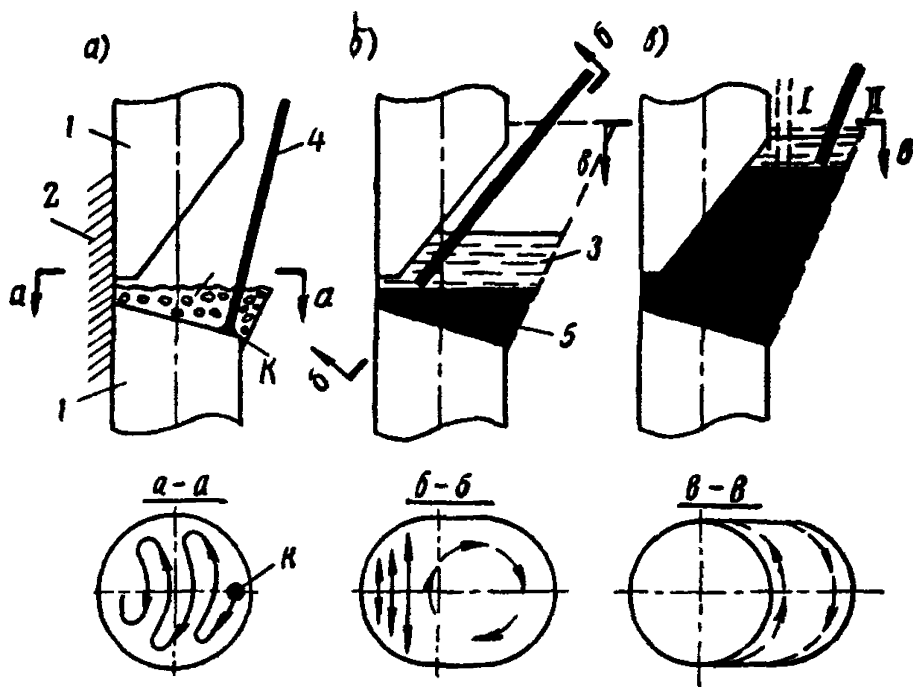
Техника полуавтоматической ванный дуговой сварки стыковых соединений вертикальных стержней диаметром ≥ 32 мм
